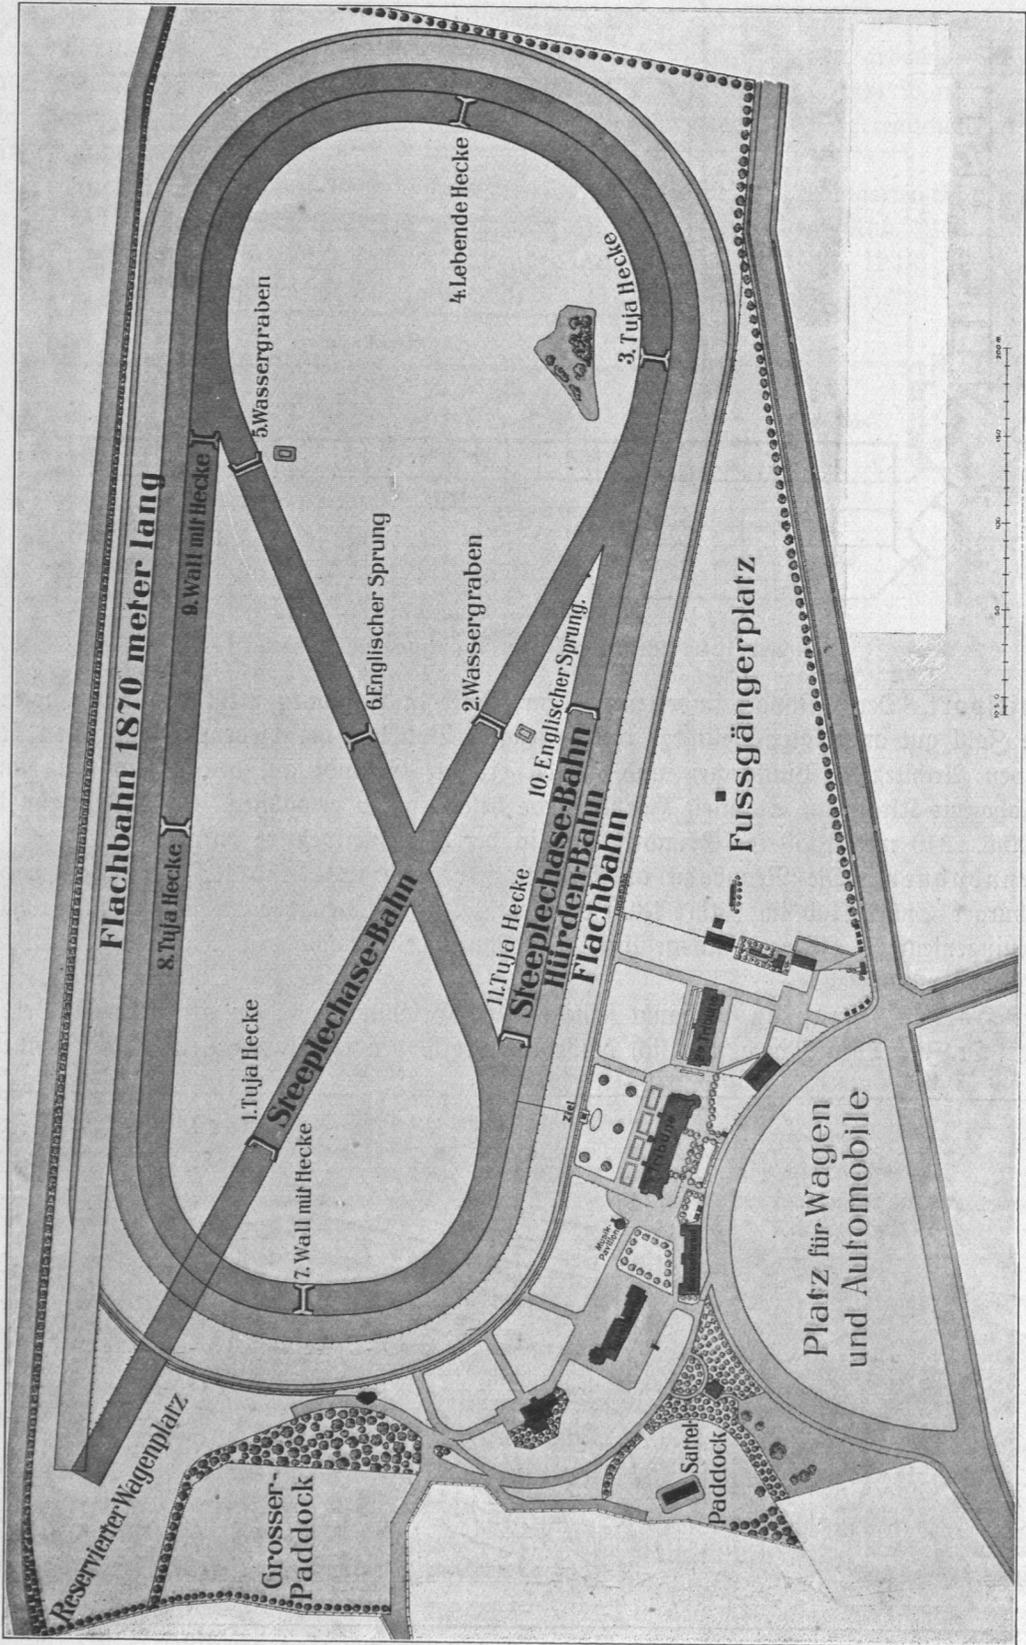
Rennbahn des Hamburger Sport-Club in Groß-Borfel, Grundriss.
